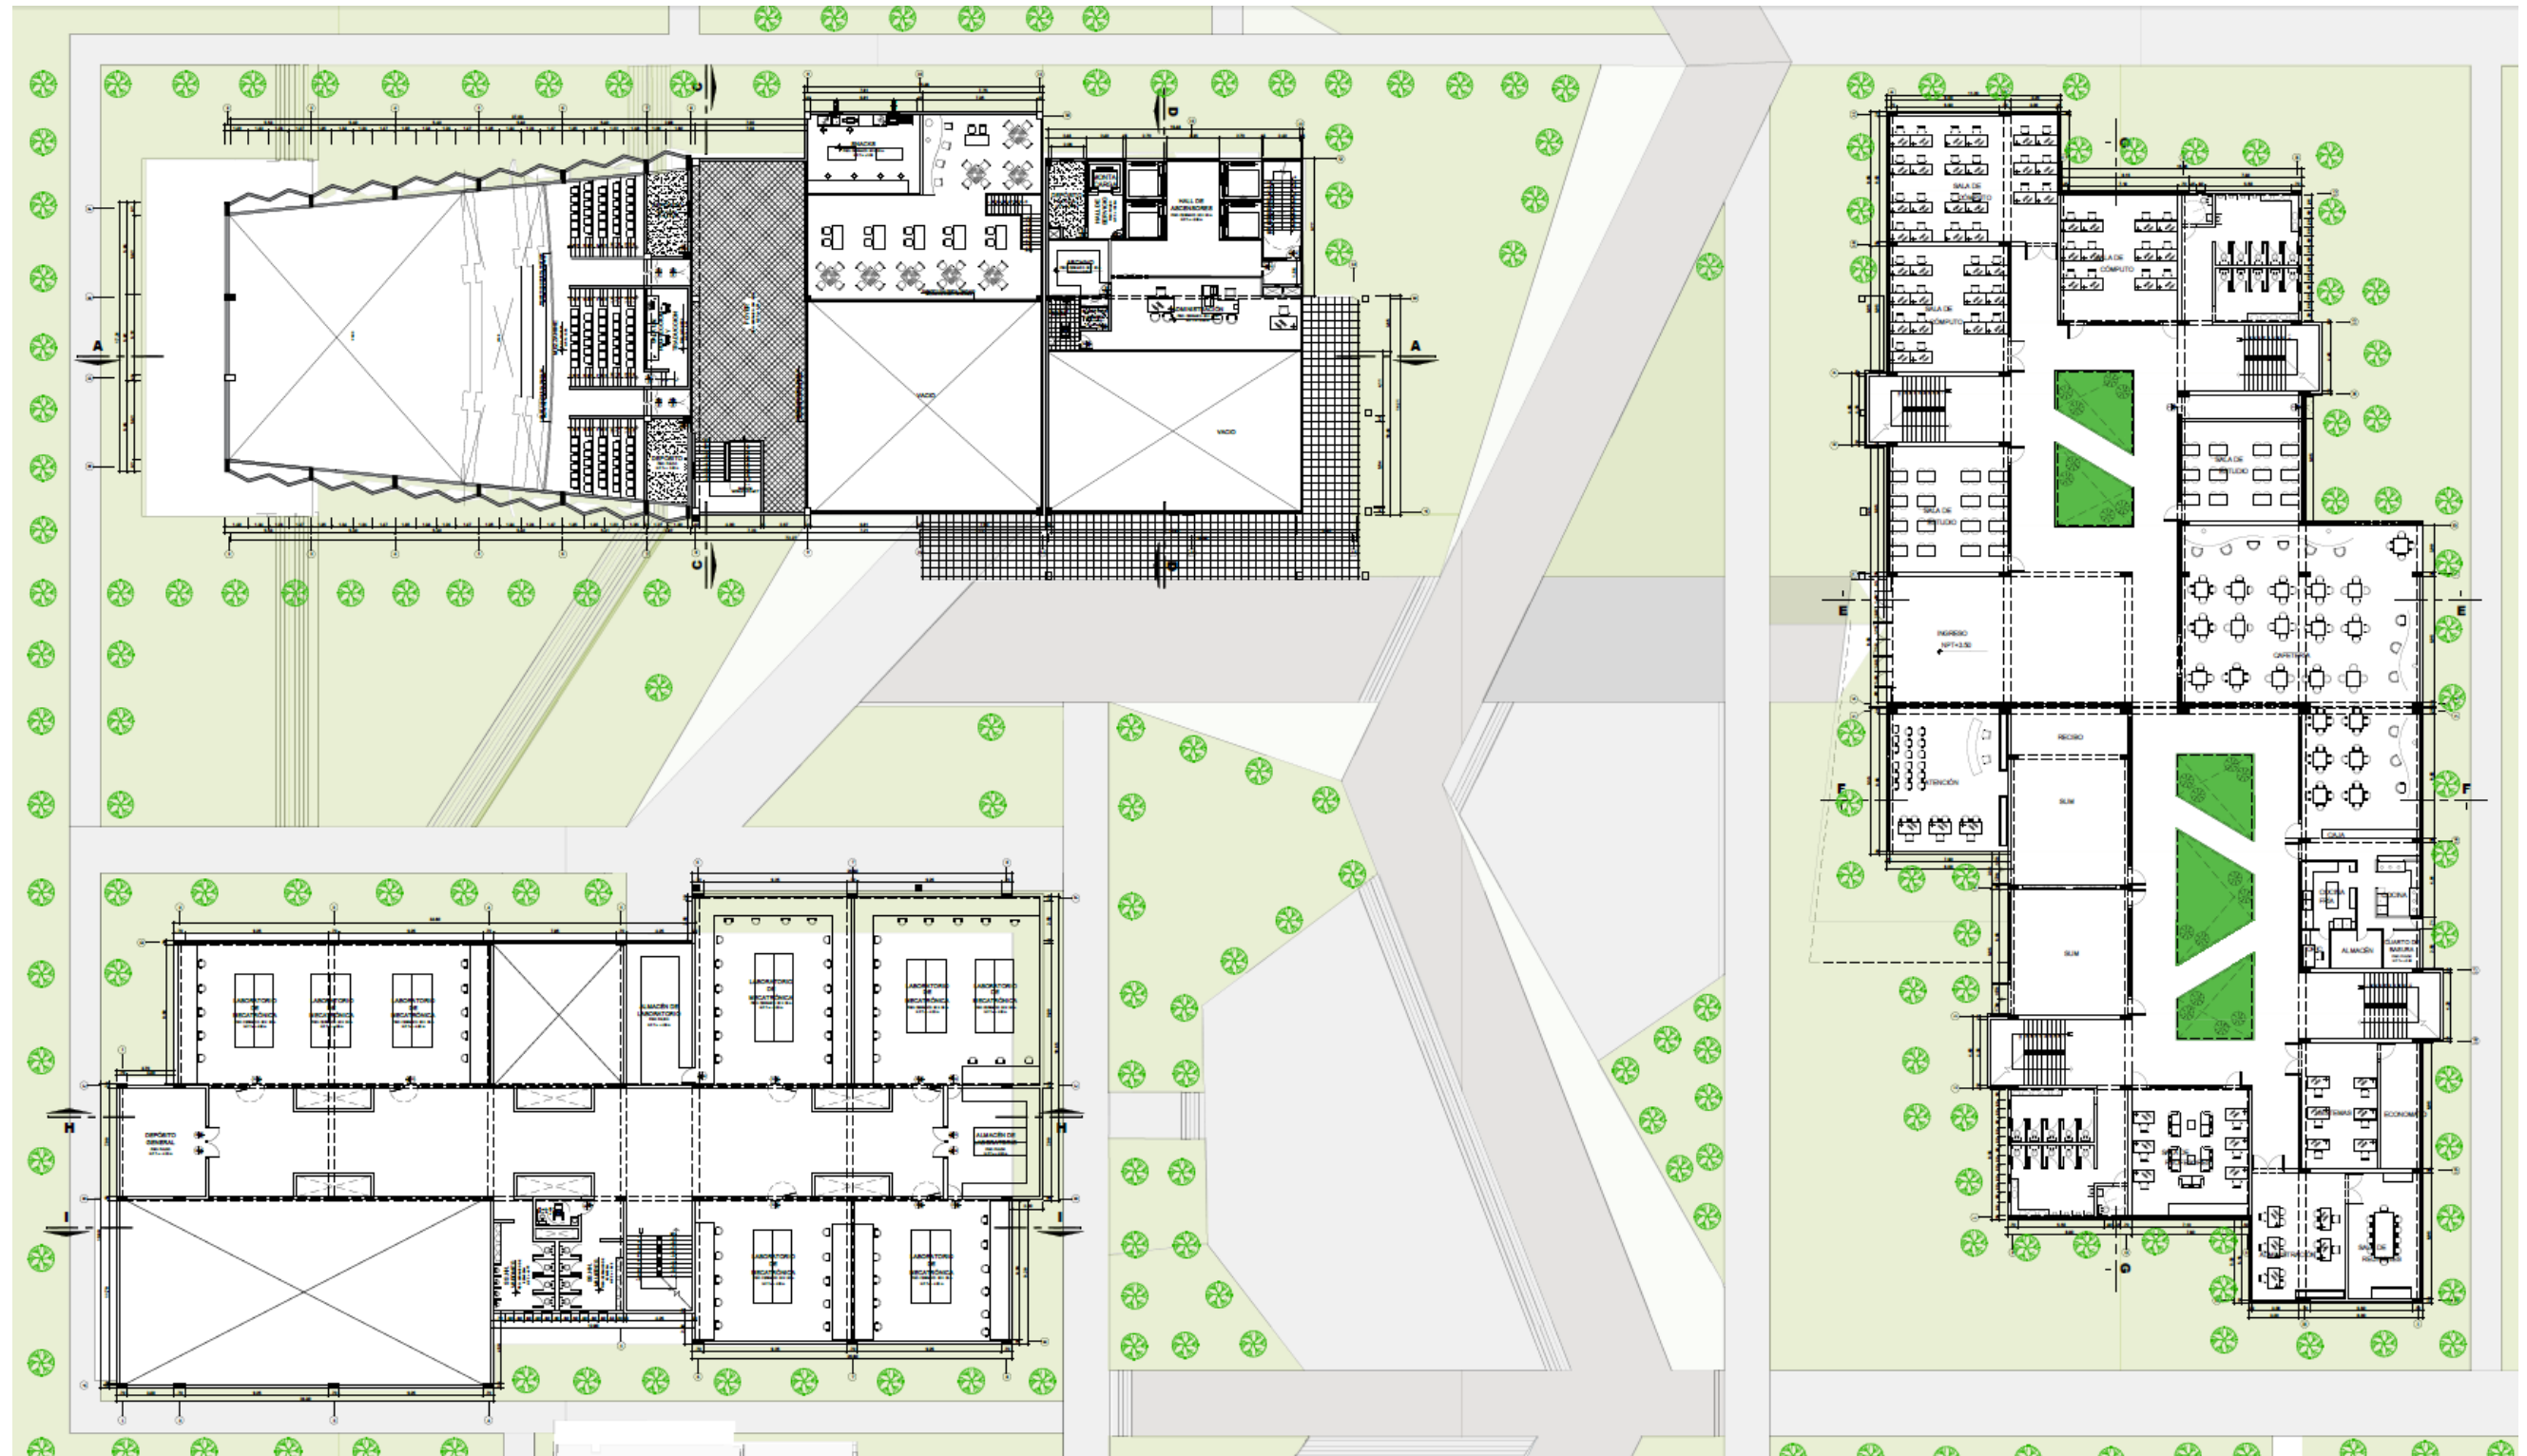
Plano Segundo Nivel del Proyecto. Elaboración Propia.
